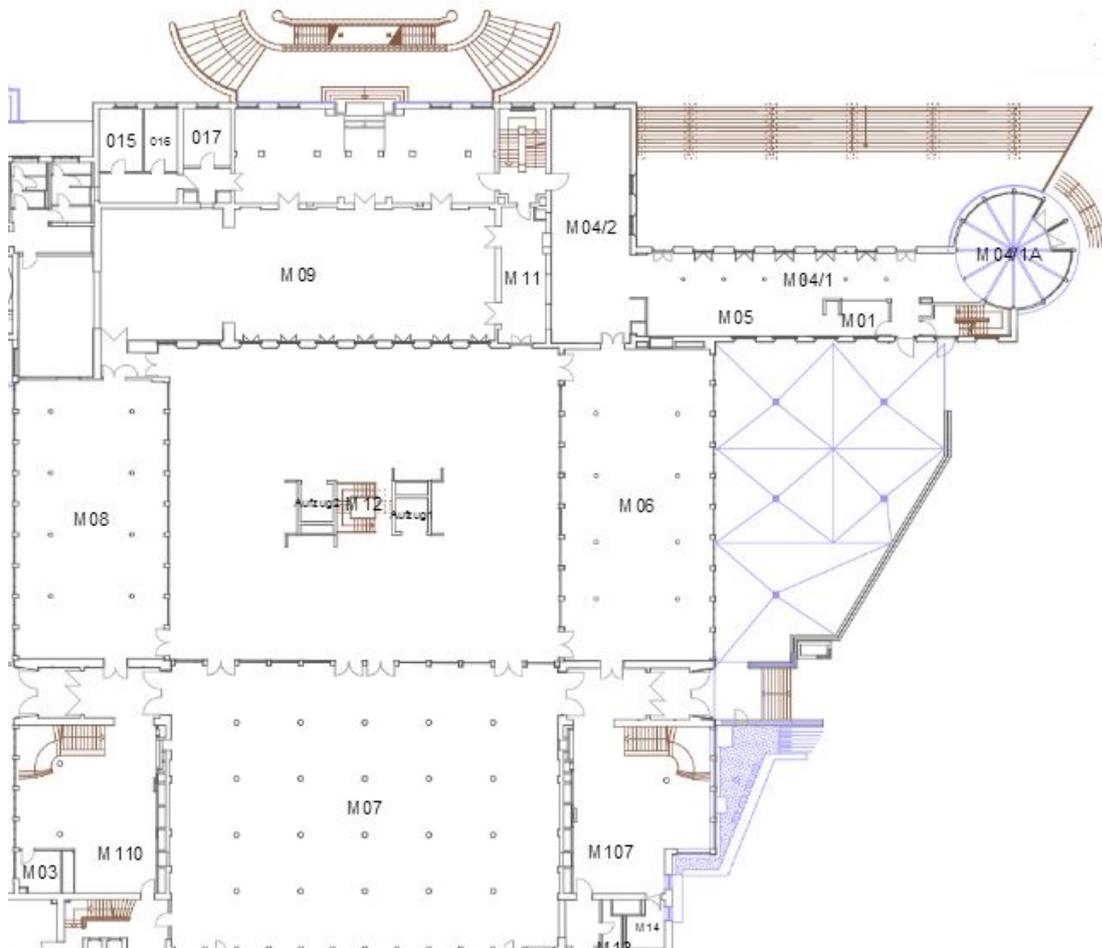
Der Grundriss zeigt den Aufbau der Mensa mit ihren verschiedenen Räumen. <http://navigator.tu-dresden.de/etplan/m13/00>
